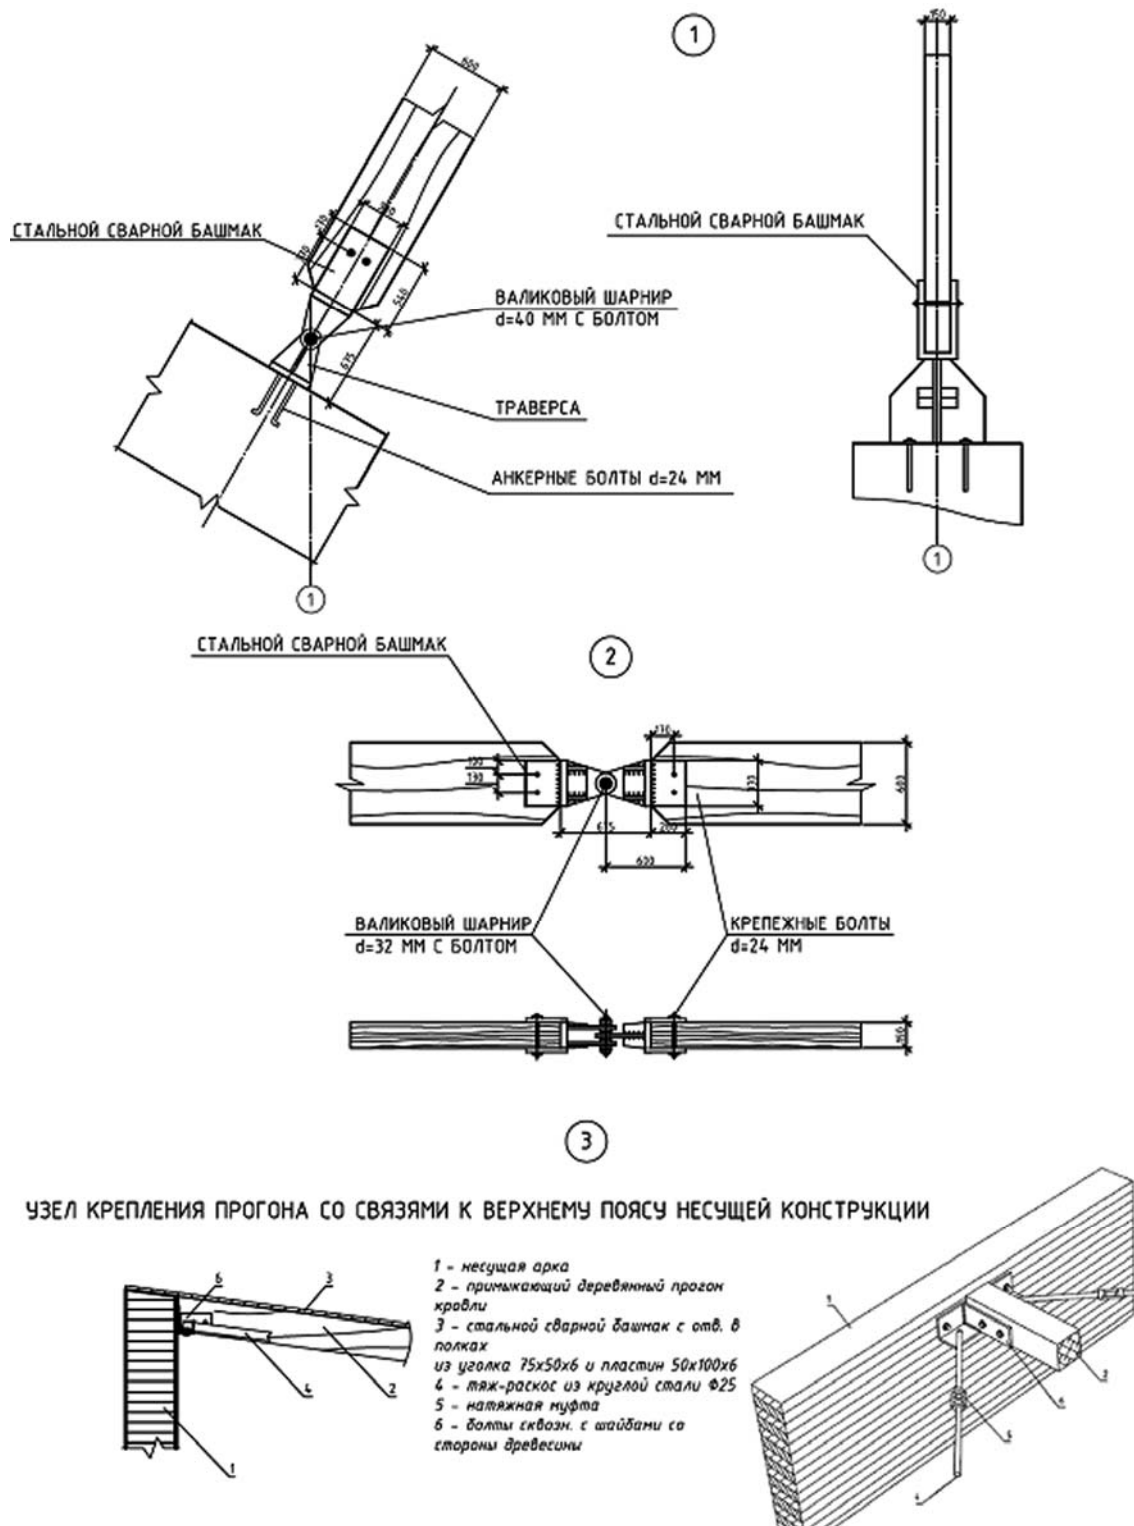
Узлы сопряжения монтажных элементов с фундаментом и между собой (1 и 2). Узел крепления прогона со связями к верхнему поясу несущей конструкции (3)
